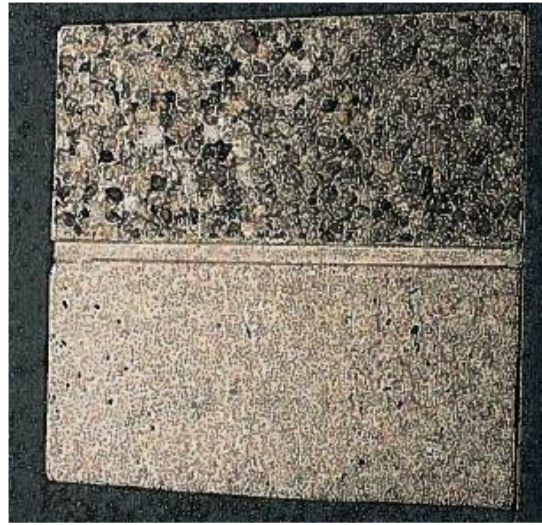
Prekast betonların renk, yüzey ve dokularını gösteren örnekler (URL 3)
